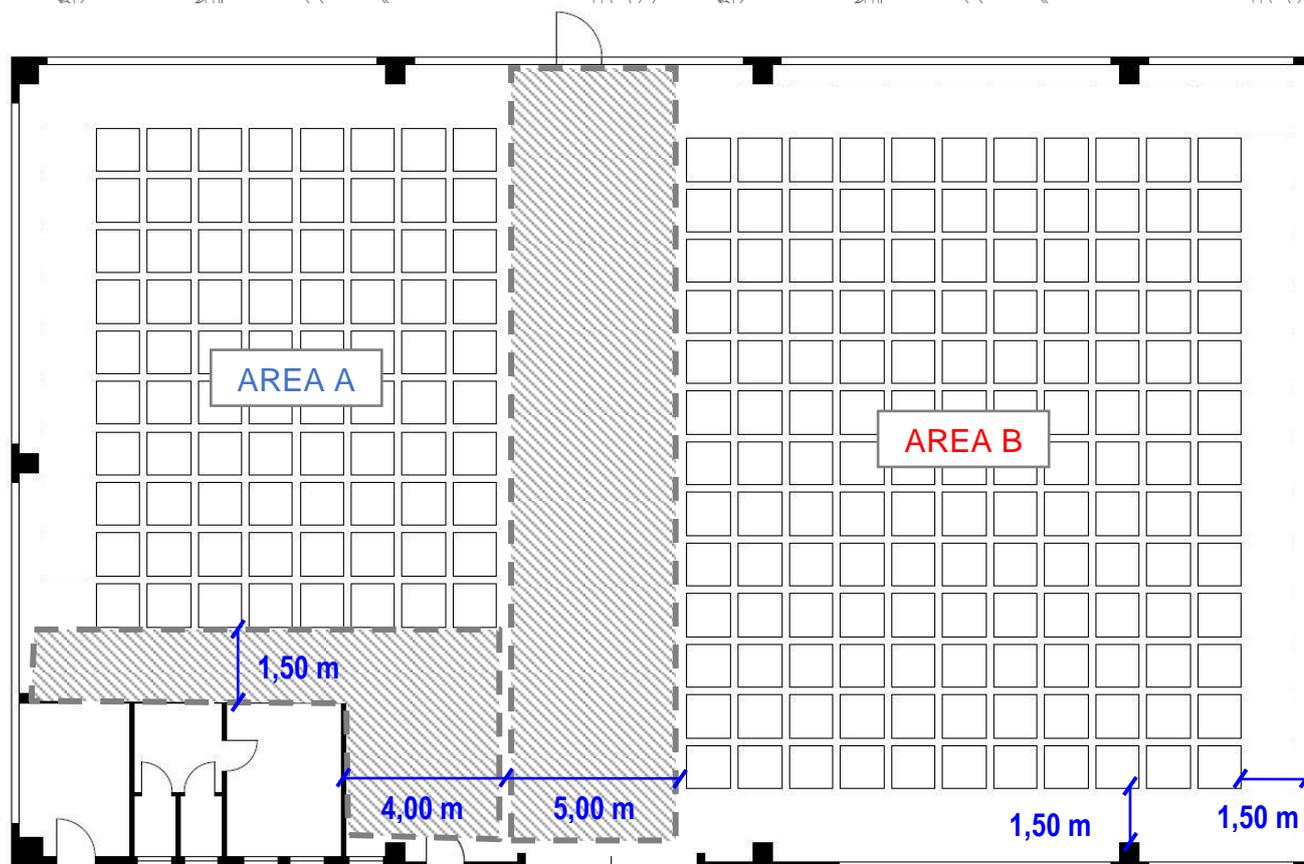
Schema planimetrico delle distanze minime da rispettare.
